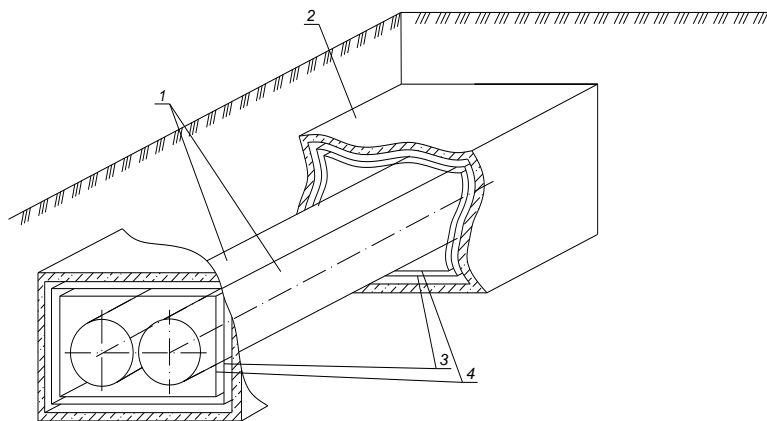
Устройство для утилизации тепловых потерь в канале теплотрассы: 1 – трубопровод тепловой сети; 2 – железобетонная оболочка канала; 3 – теплоотражающий экран; 4 – теплоотражающий экран
